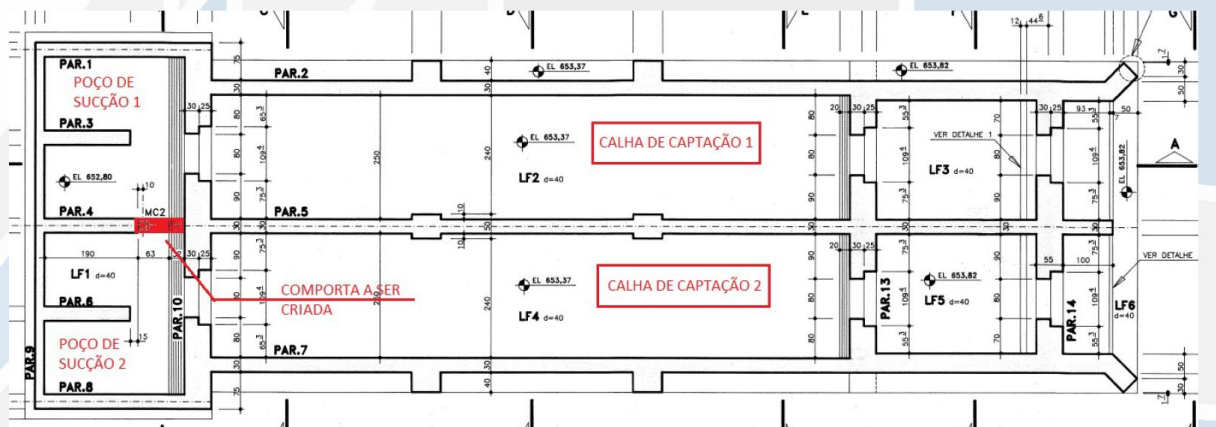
Planta inferior do tanque - Croqui das intervenções a serem realizadas
